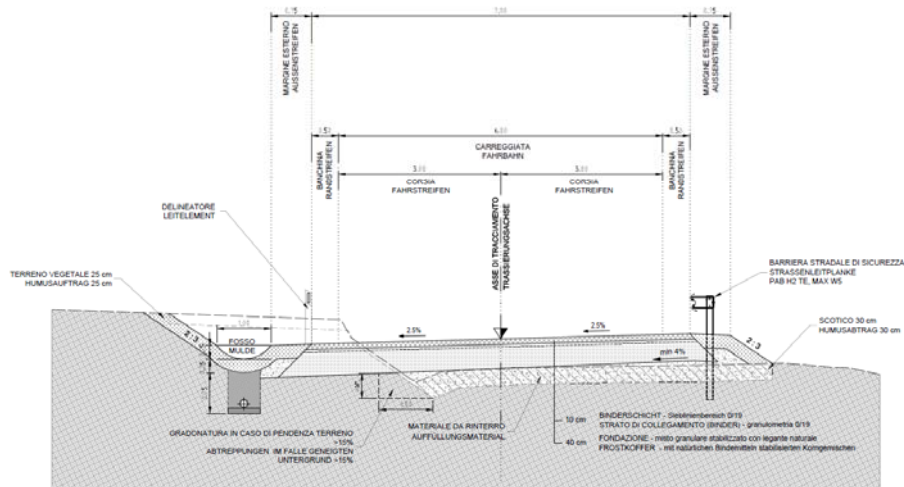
Regelquerschnitt Baustellenstraße Abschnitt A
